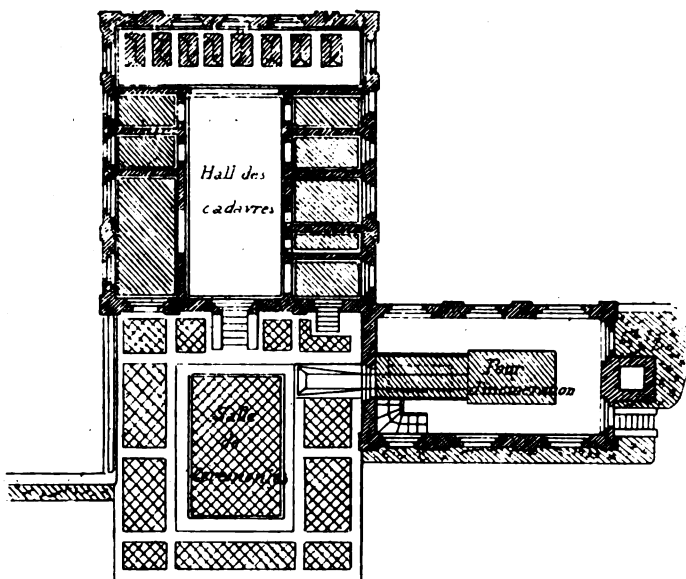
Plan du four crématoire d'Offenbach (système Klingenstierna).
